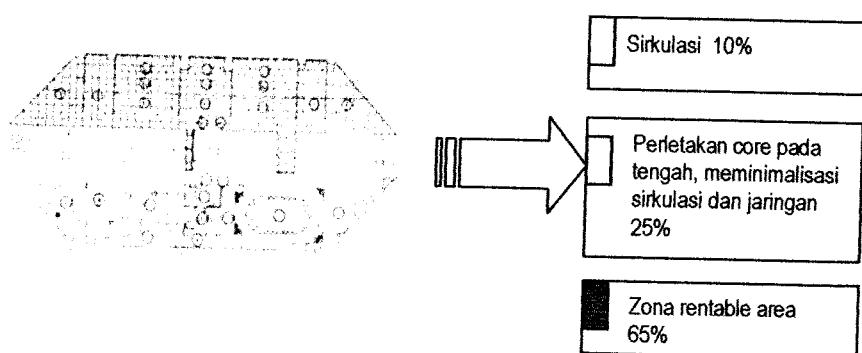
Pembagian zona fungsi ruang antar lantai
